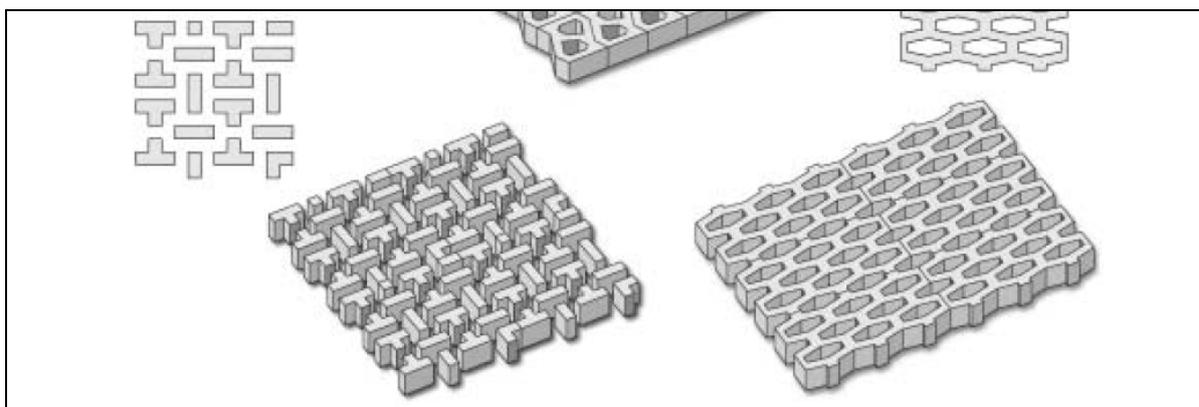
Tipologie di pavimentazione utilizzabili a progetto
